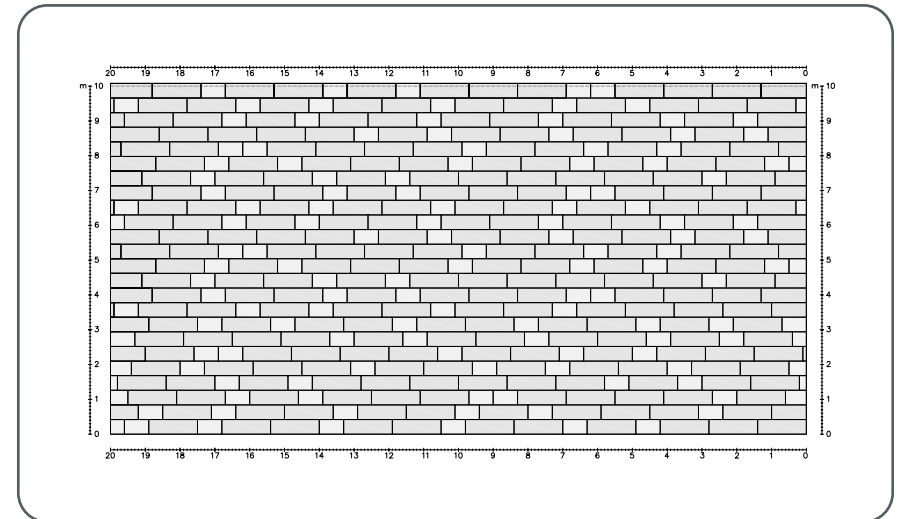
Panneau de façade FX.12 – Exemple de pose 1
